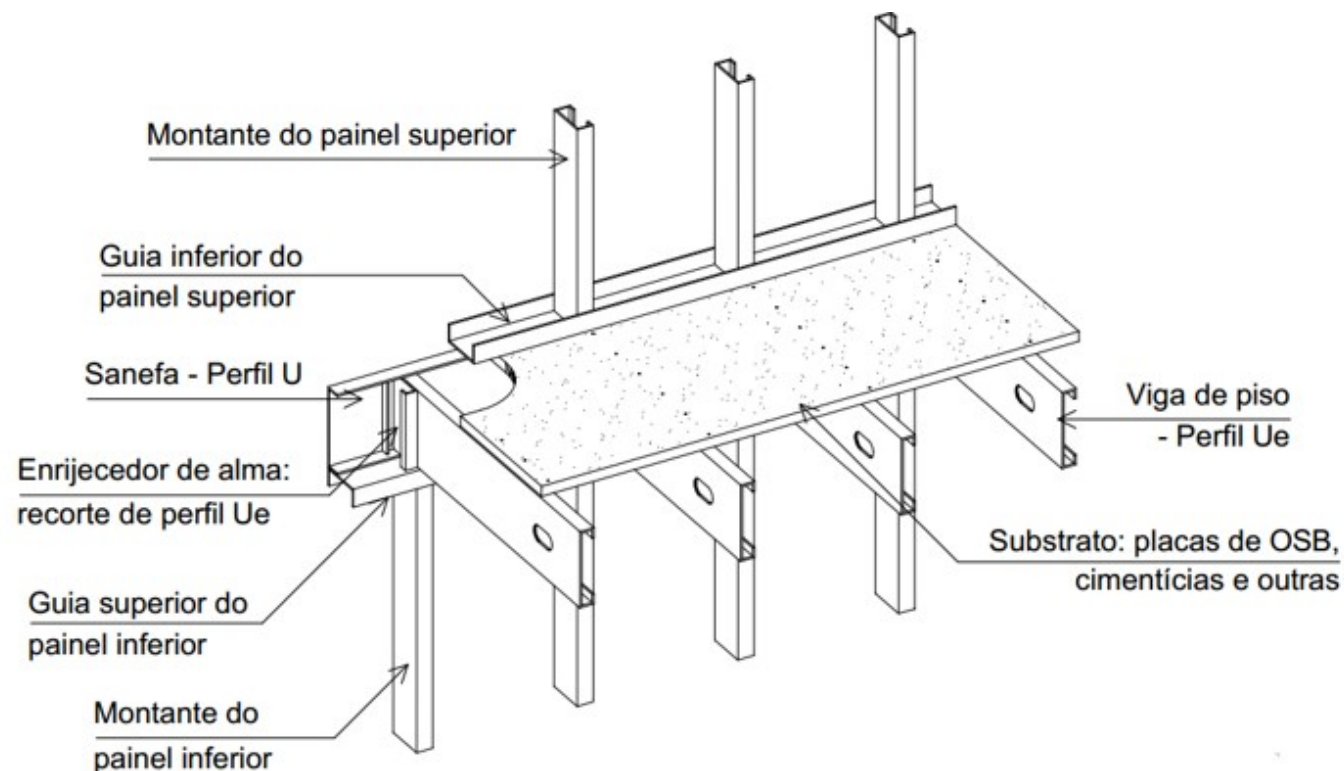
Estrutura típica de laje de LSF com substrato seco
